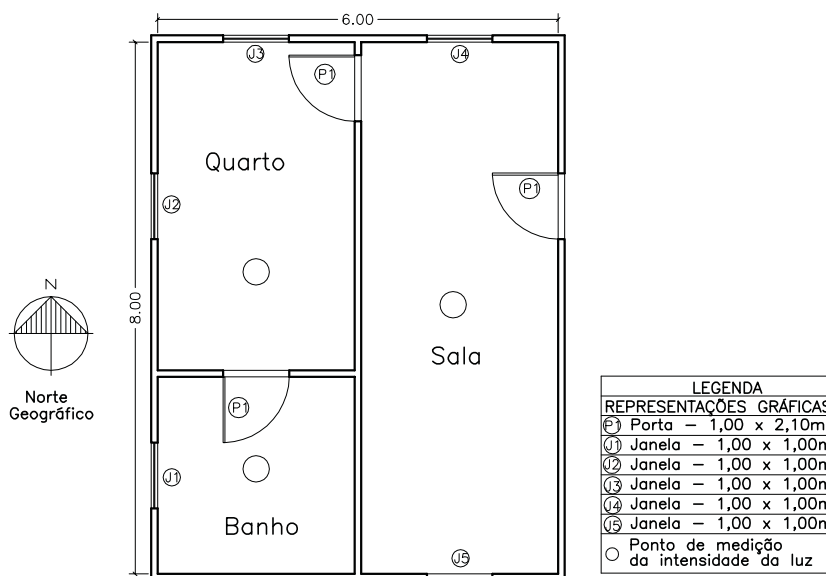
Casa Original – Estudo de Caso 2 – Planta Baixa
